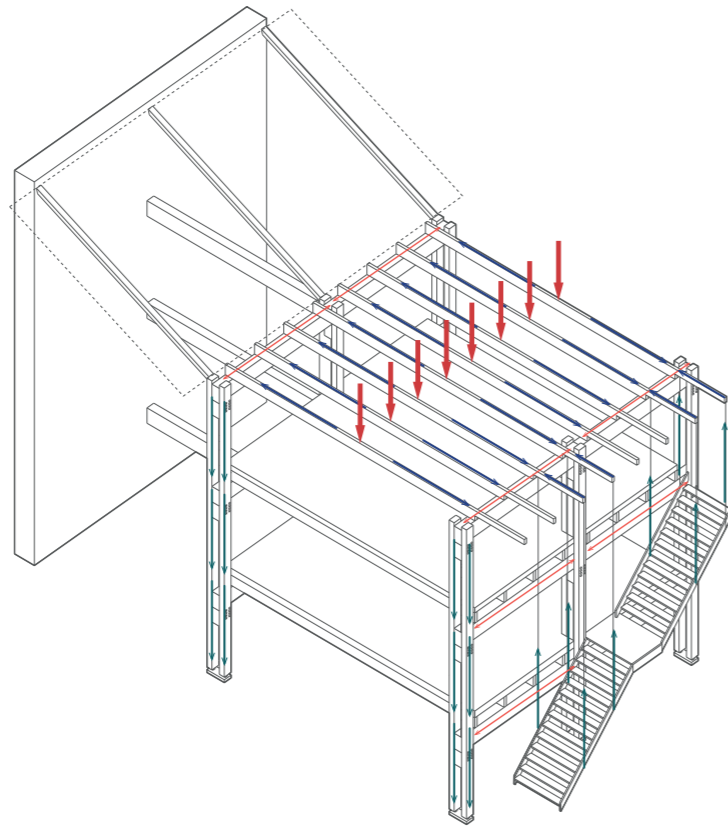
Apoyo de las vigas principales en fachada sobre los tacos entre pilares. Adaptado de *Colonnade* [Fotografía], por RSHP, 2004.
